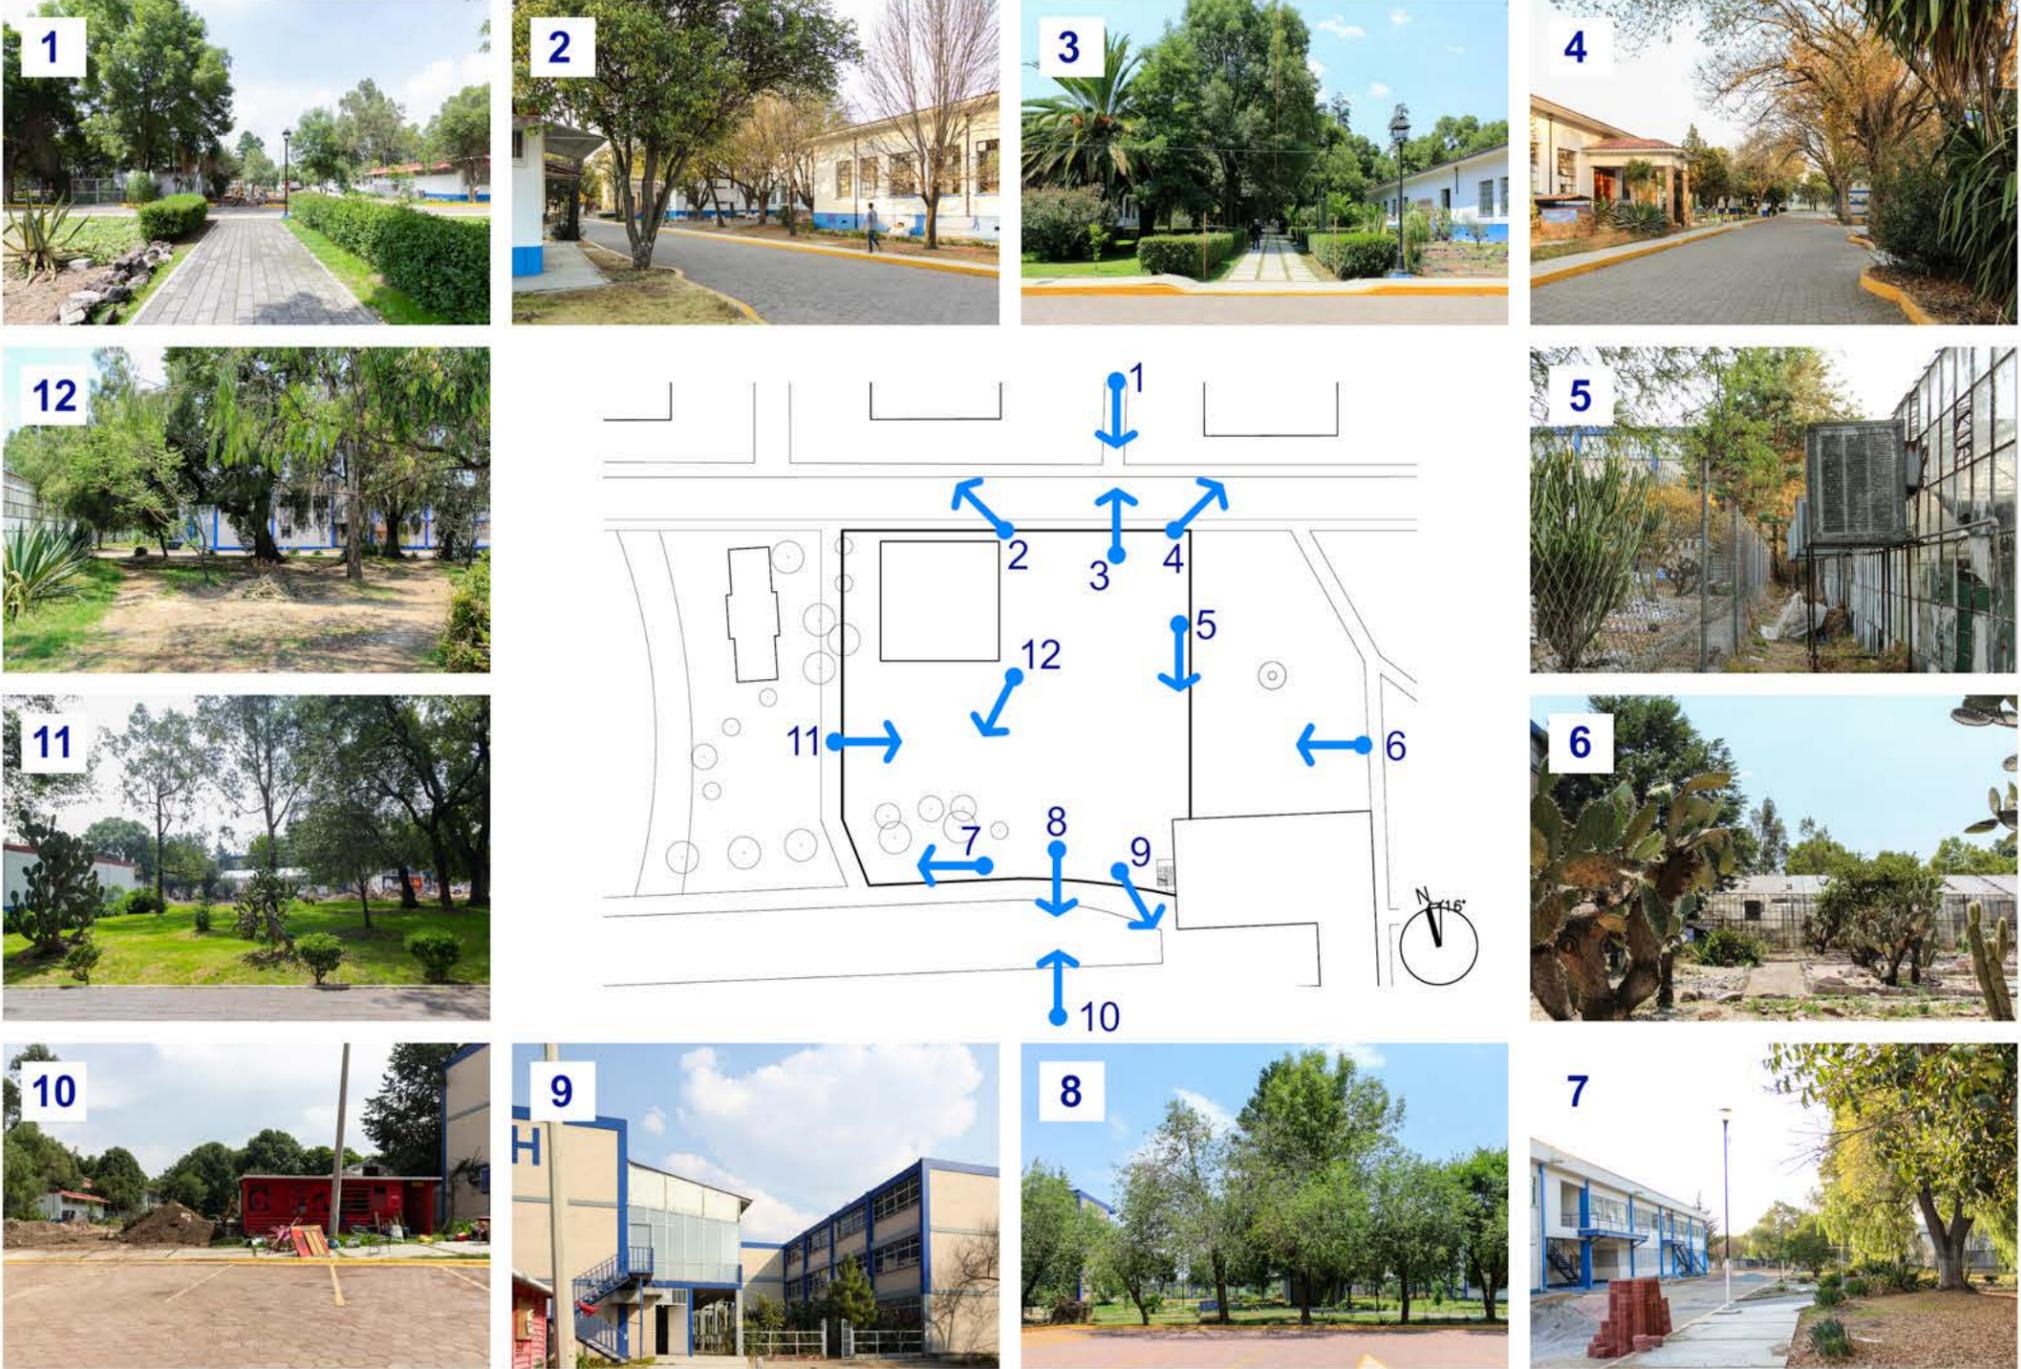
Plano del terreno con las vistas hacia/desde el terreno.
